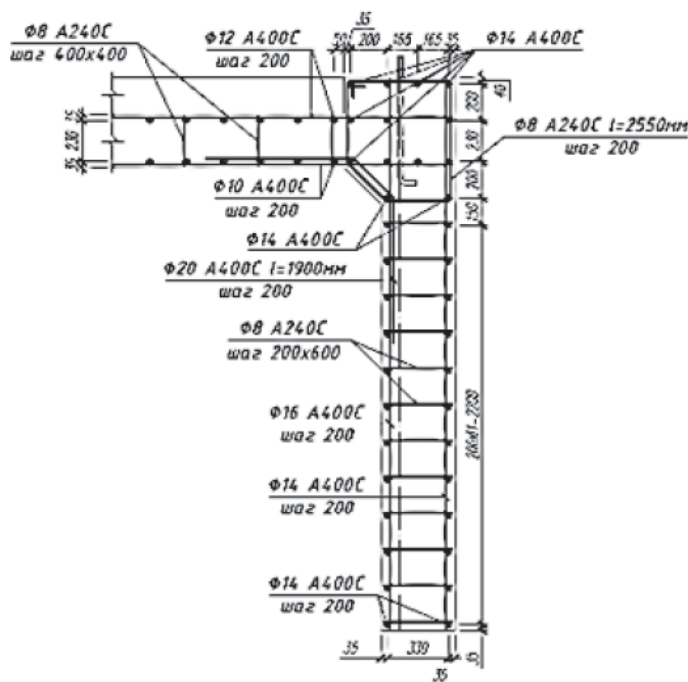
Поперечний переріз фундаменту з силовою плитою підлоги, армованої на розпирні зусилля
